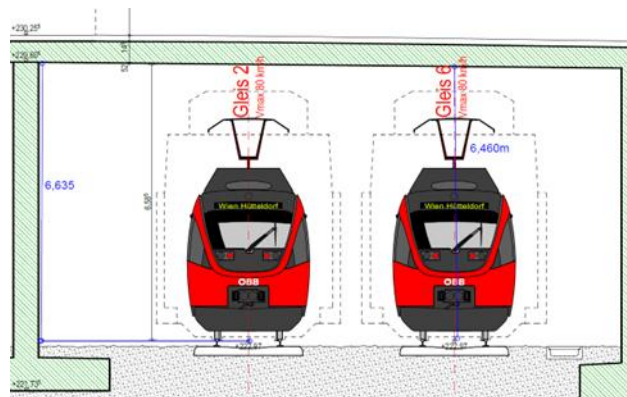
Auszug aus ÖBB Plan 480-3-4_ST-Schnitte Schnitt 3-3, blaue Koten aus Plan gerechnet
